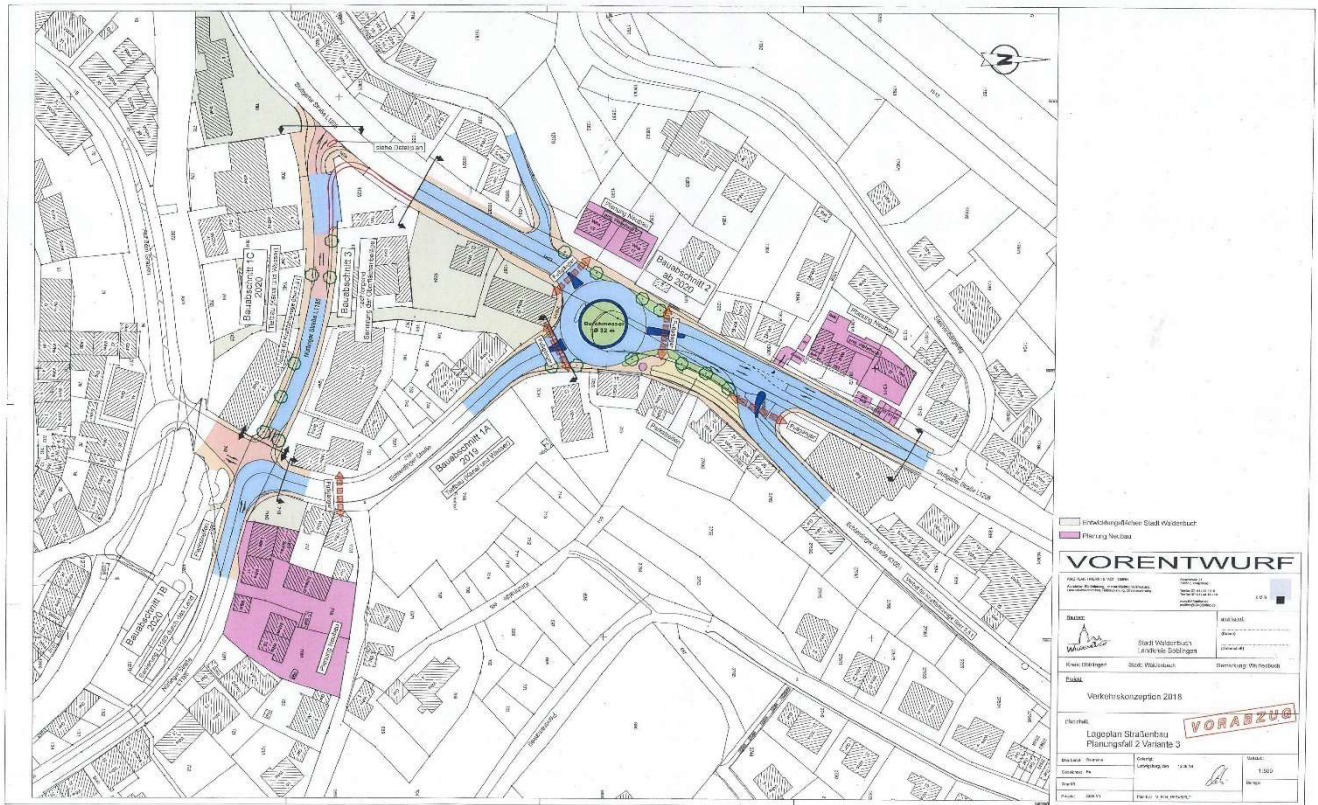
, Lageplan Straßenbau, KMB PLAN | WERK | STADT | GmbH, 2018
